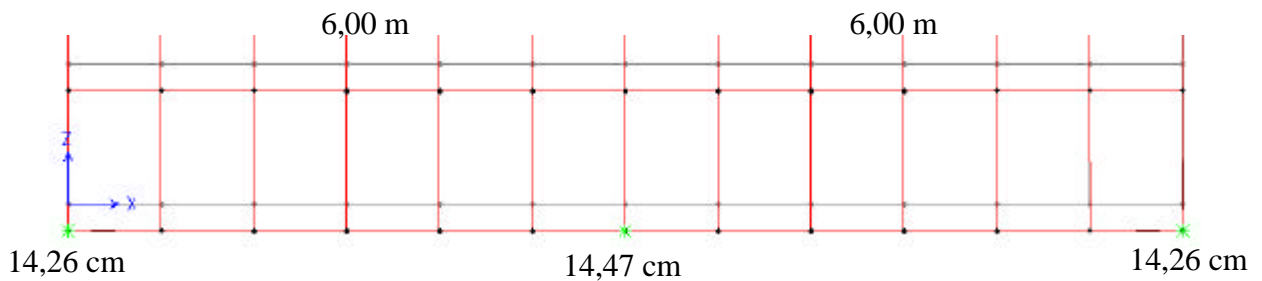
Rotação da viga de fundação do pórtico plano central levando-se em consideração a ISE e utilizando paredes de alvenaria.
